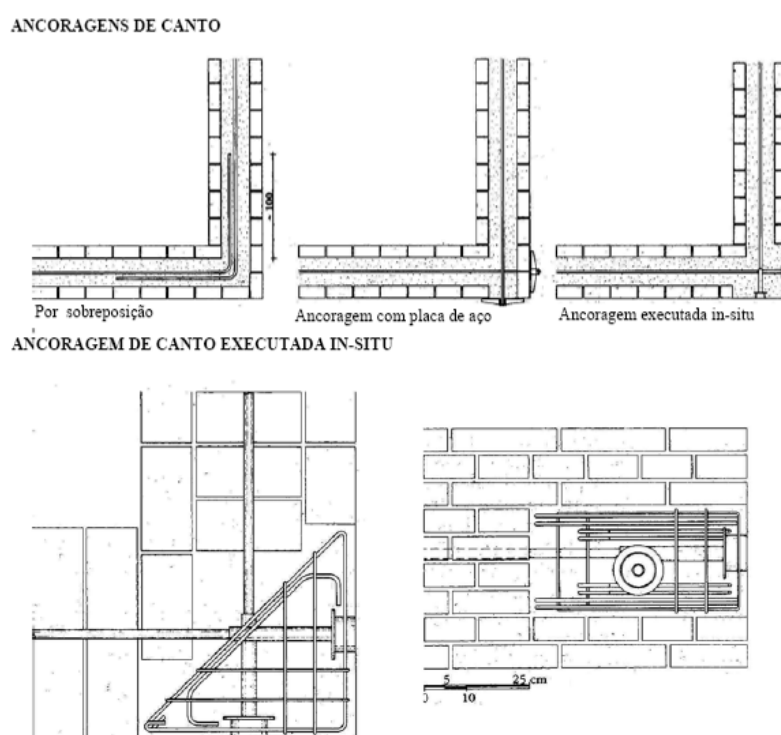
Exemplos de aplicação de pregagens com direcções ortogonais para o reforço de ligações entre paredes (Giuffrè, 1993).
